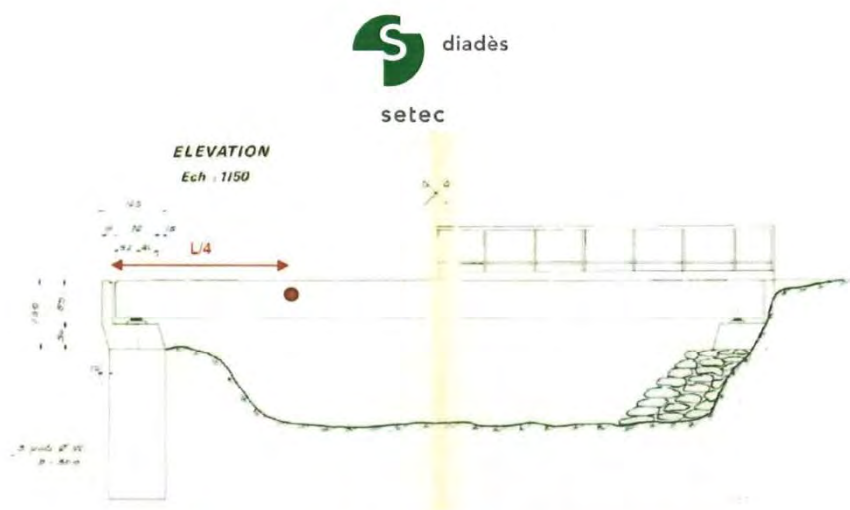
Implantation des carottages (extrait du rapport du LERM)
